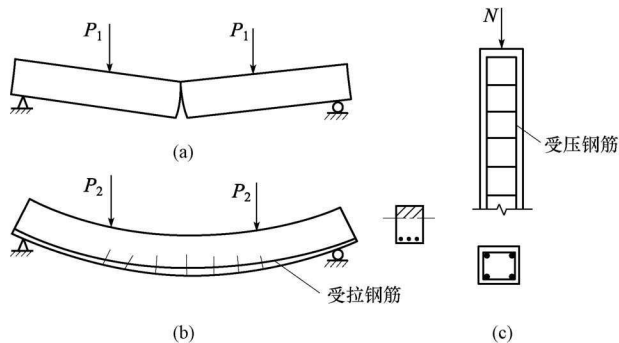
素混凝土梁及钢筋混凝土梁、柱
